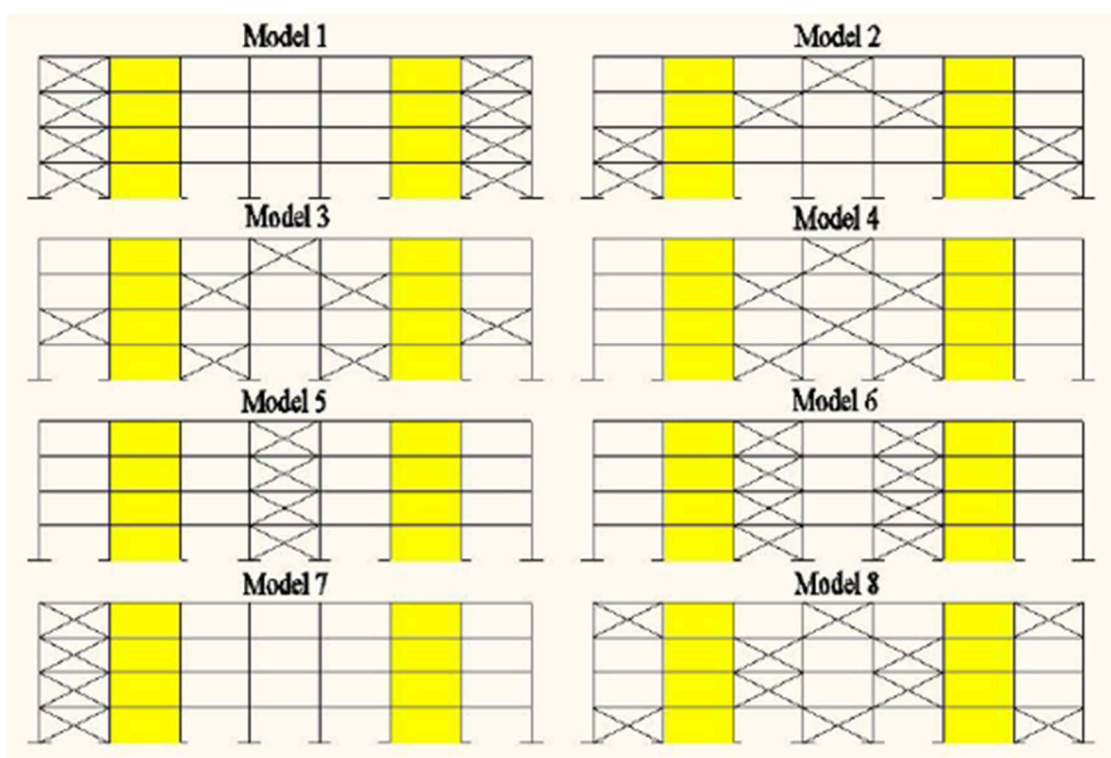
Modele de amplasarea a contravântuirilor în elevație [1]
